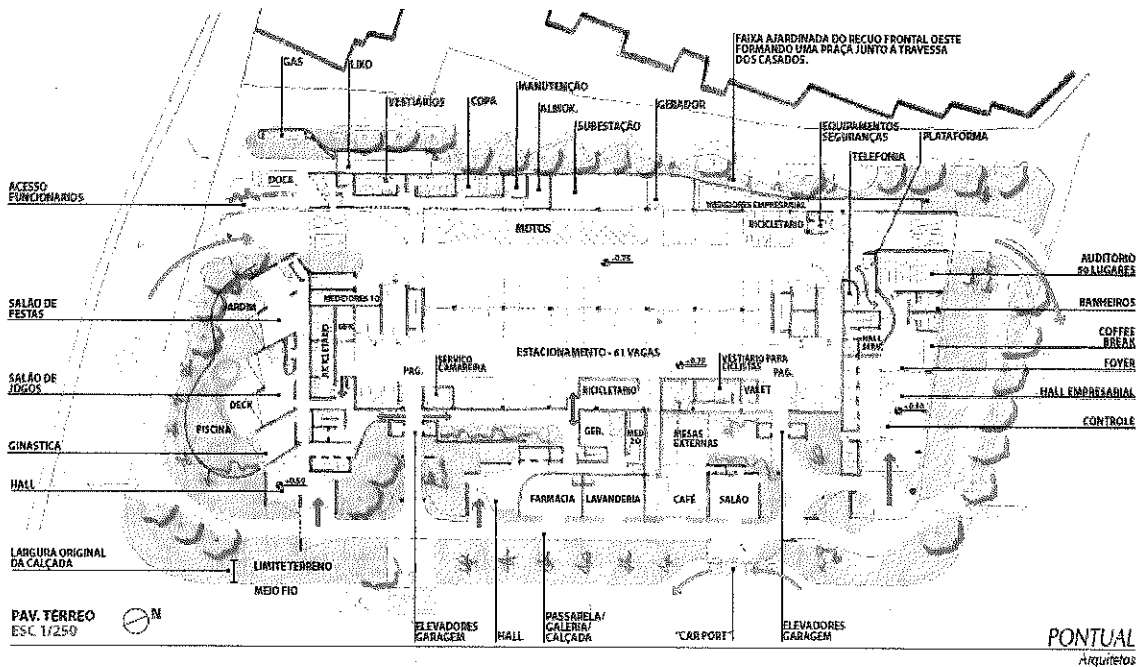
Planta Baixa pavimento térreo da nova proposta. Fonte: Autor do Projeto
